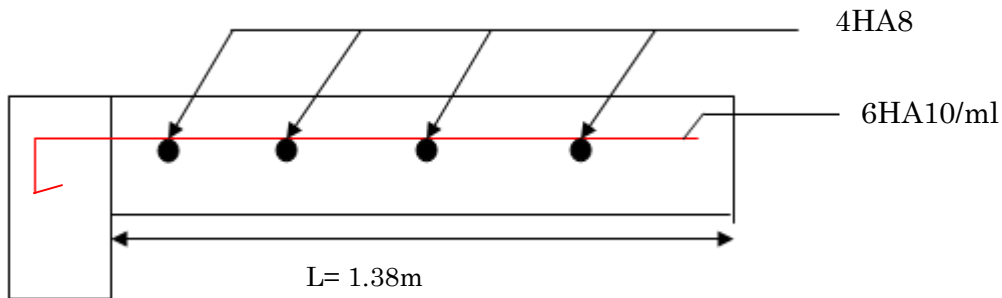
Schéma de ferrailage de la dalle porte à faux
